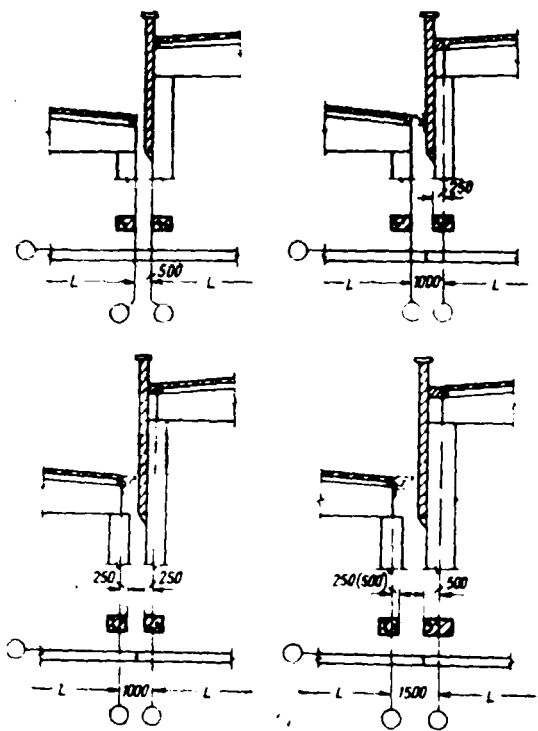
Привязка колонн в местах перепада высот между пролетами одного направления
